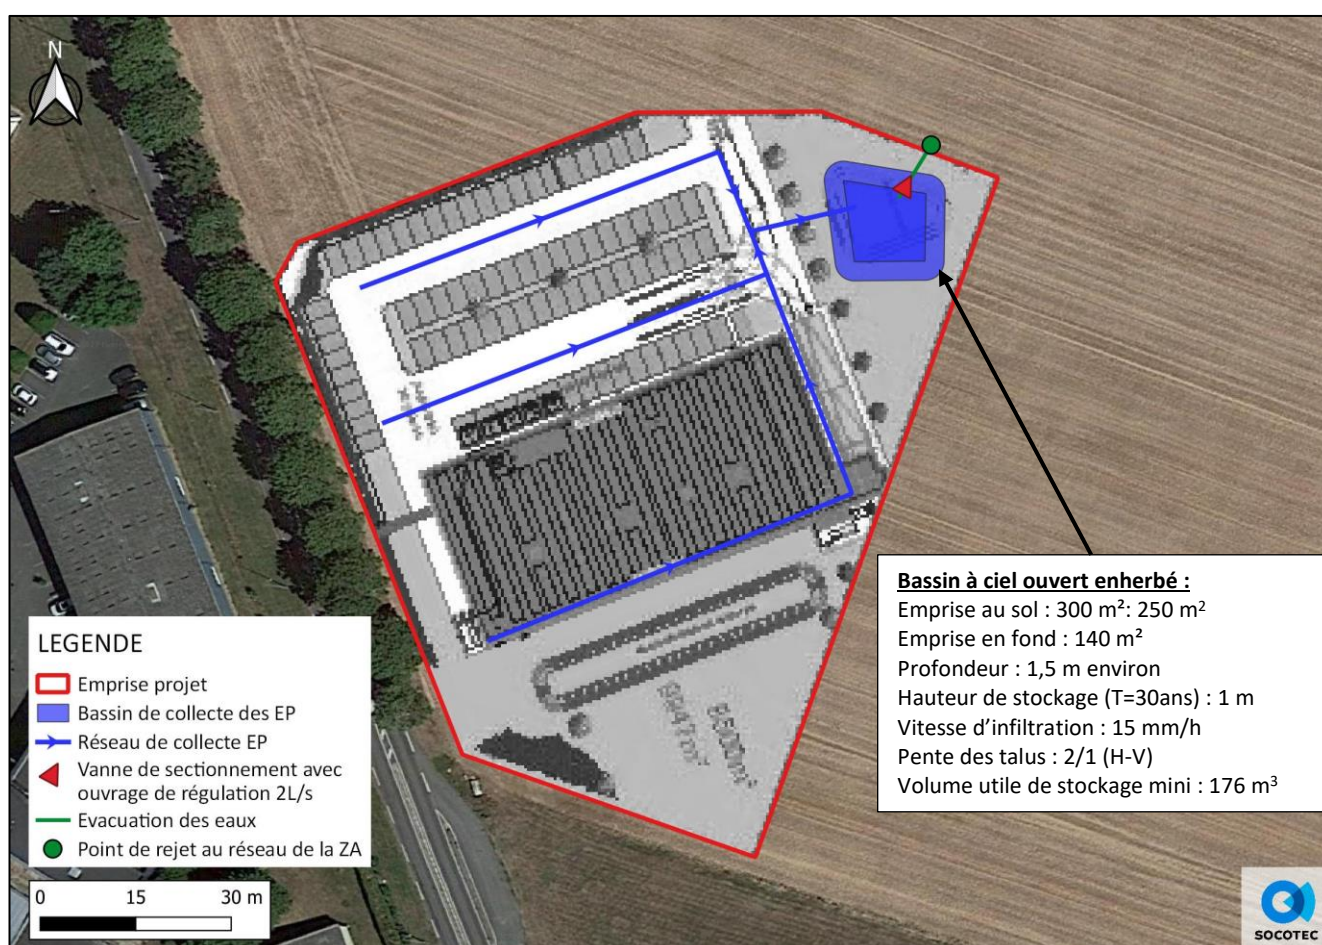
Schéma de principe d'assainissement des eaux pluviales
